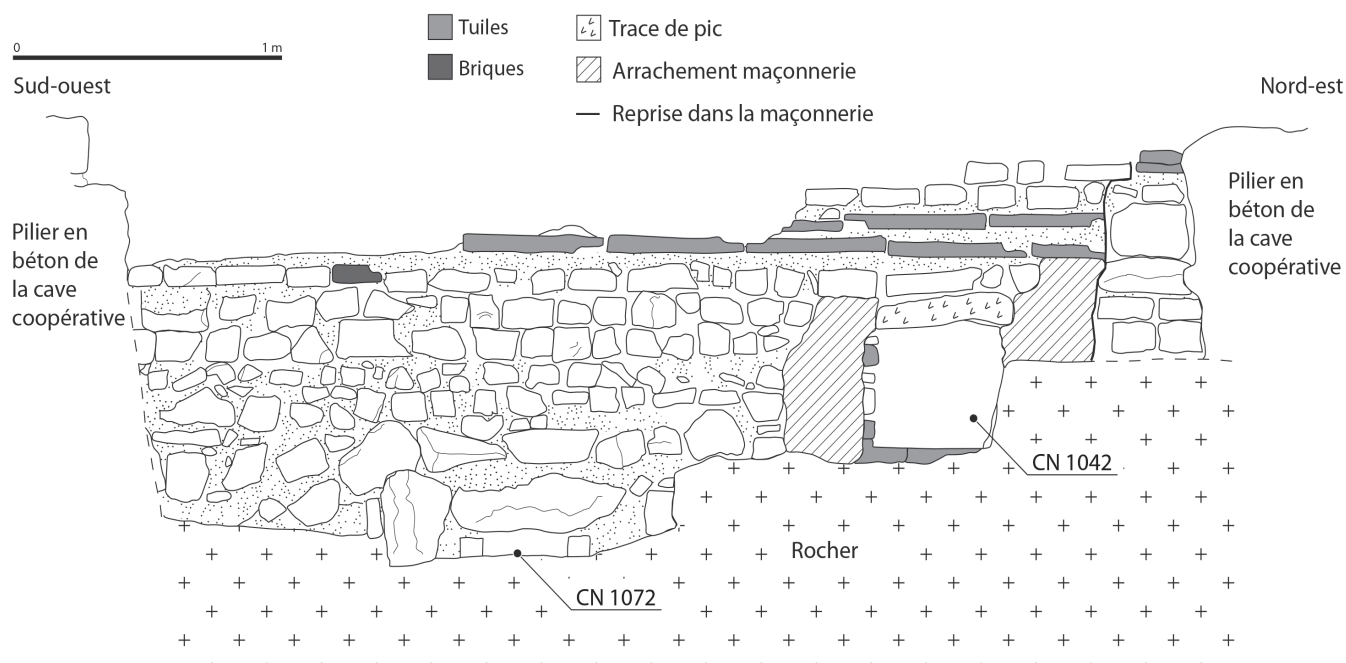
relevé pierre à pierre de l'élévation du mur 1035.
